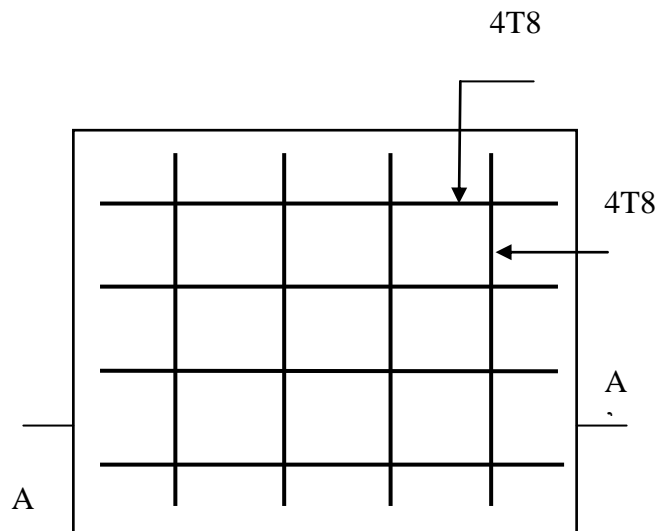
Schéma de ferrailage de la dalle Type (1).
